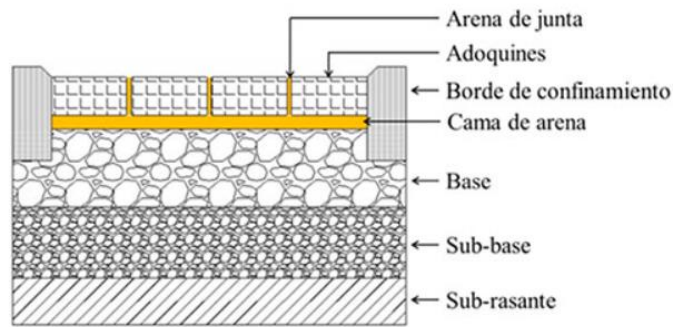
Elementos estructurales de un pavimento de adoquín de concreto (ASCE, 2010)
